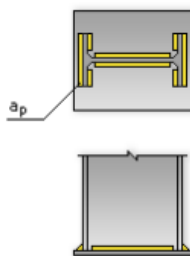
Ligação soldada entre o pilar e a placa de base
